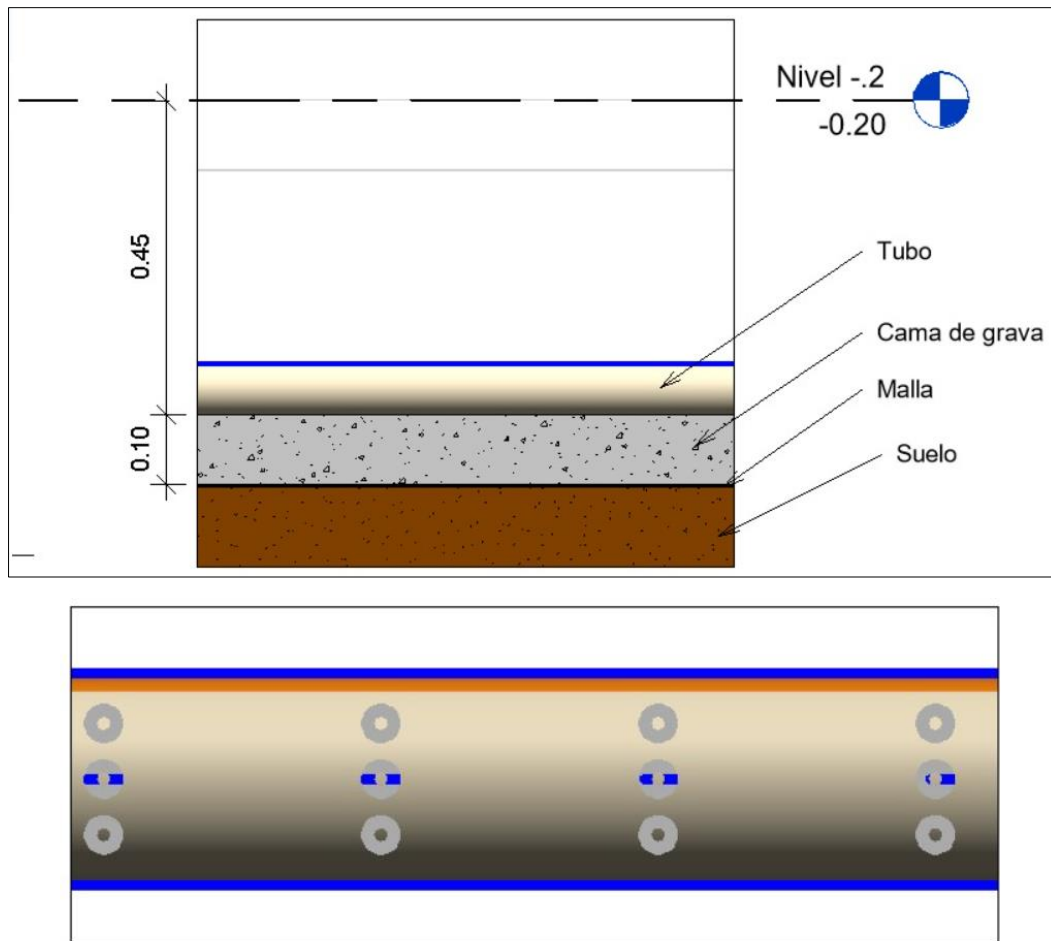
Colocación de tubería de drenaje y perforaciones en tubos
